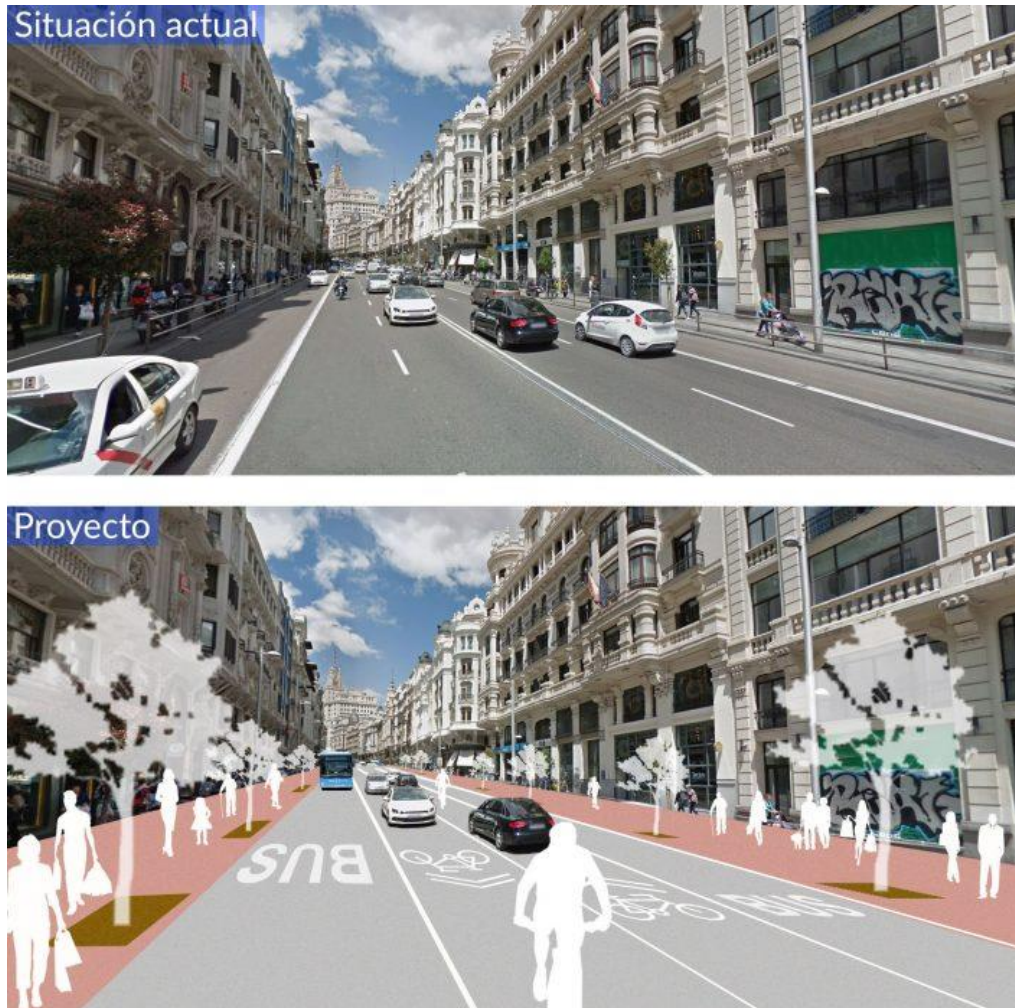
Vista en Perspectiva; Fuente: Archidally
